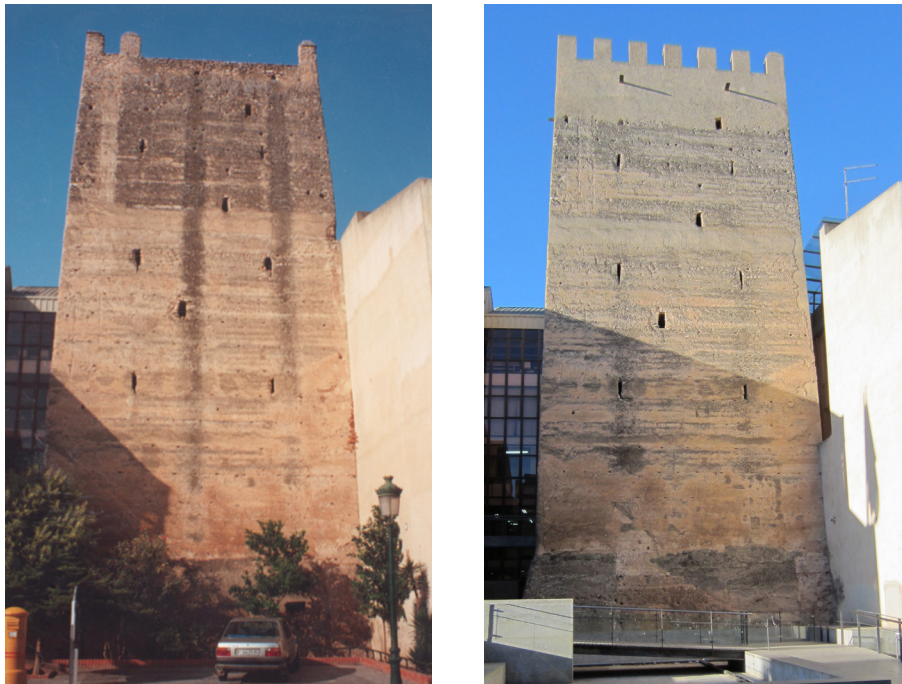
4.42. Estado anterior y posterior a la intervención de la torre de Benifaió.
